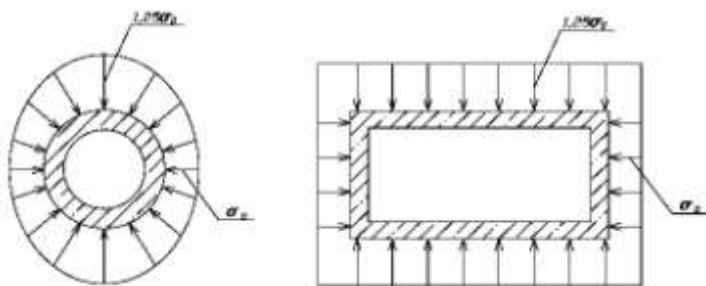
Схема к расчету стен опускного колодца на изгиб в поперечном сечении
